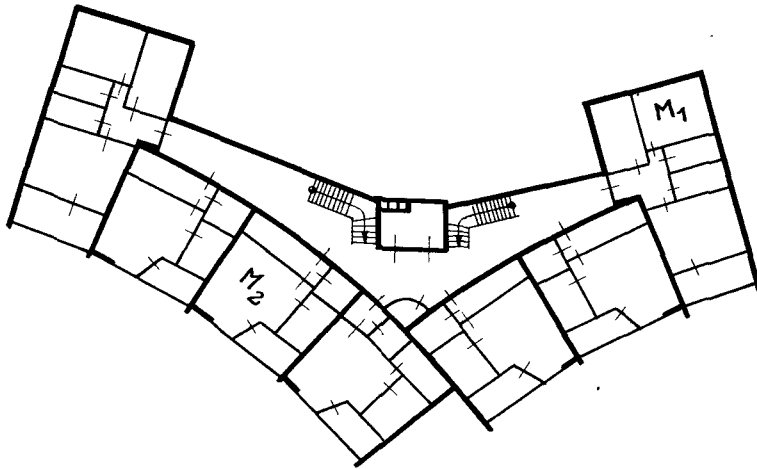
Schematische Darstellung des Hochhaus-Grundrisses in Gitterziegelbauweise.
